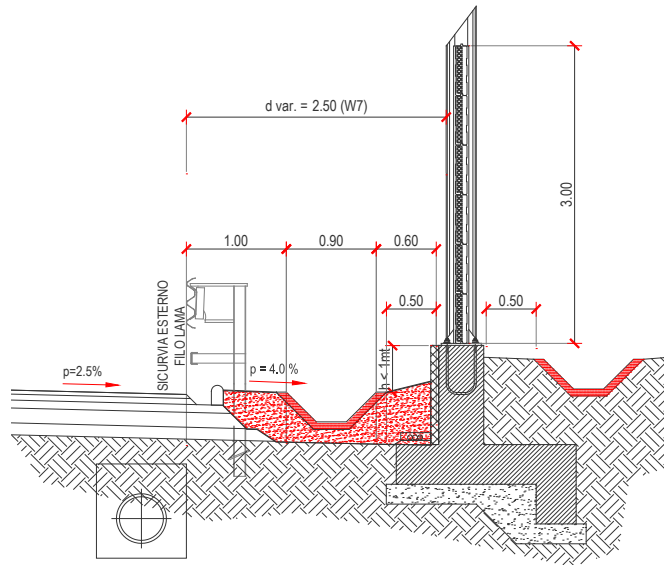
Sezione tipo di barriera con pannello fonoassorbente FA.
